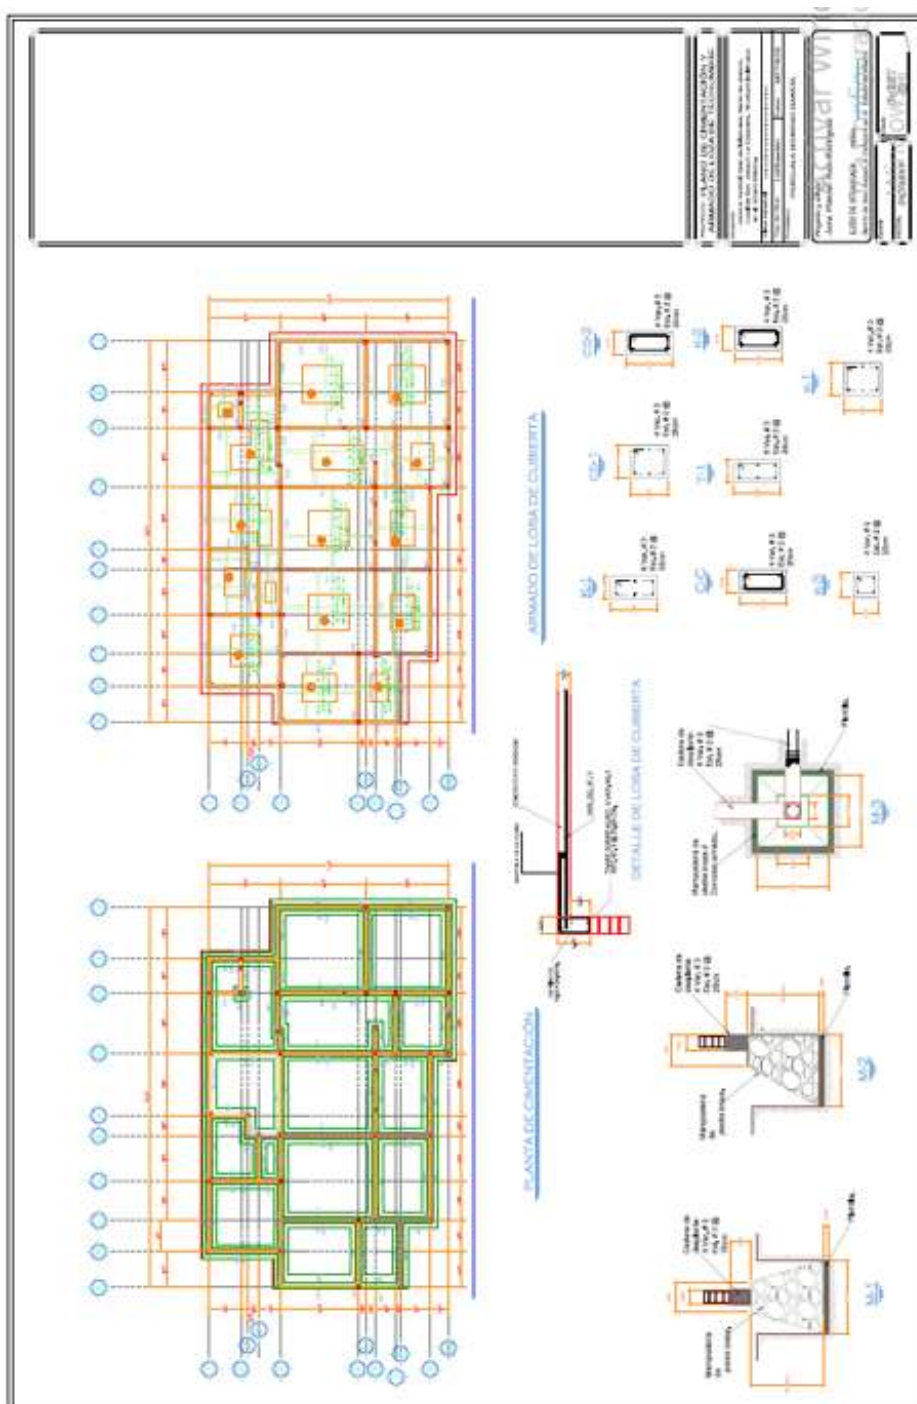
Imagen resultante la propuesta de cimentación y armado de losa, así como el tipo de cimentación central y colindancias, armado de dalas de desplante y columnas y castillo, con su respectivo, detalle de losa de cubierta. En 90x90 cm., en formato dwg. Software AutoCAD. De la C. Pascuala Moreno García en el Municipio de Ixtlahuaca.
